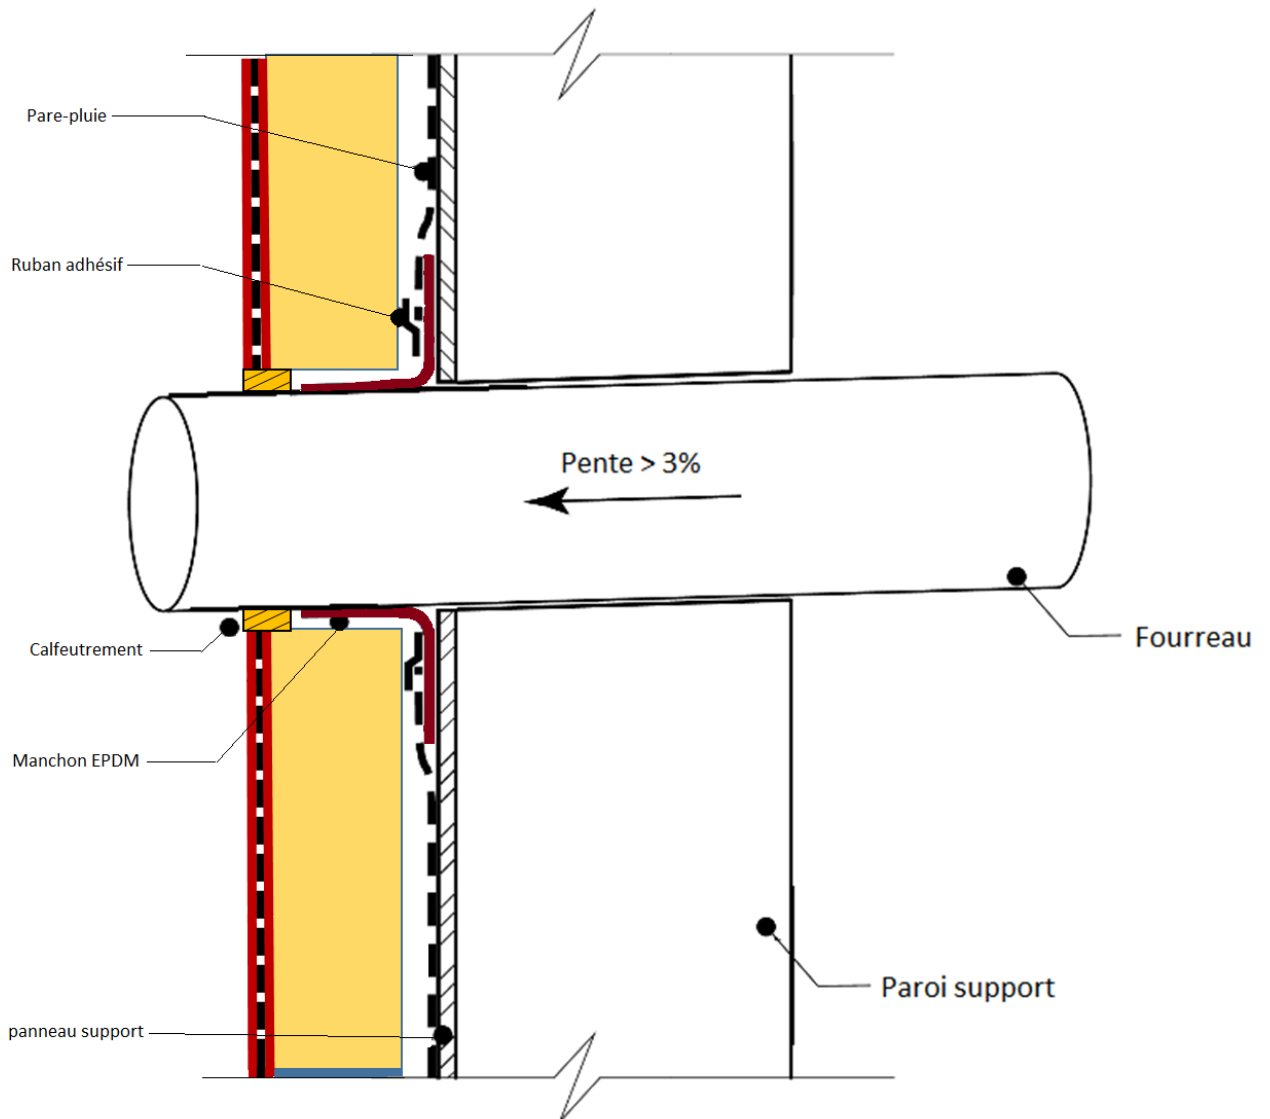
Gestion d'un élément traversant (Ee2) – coupe verticale
